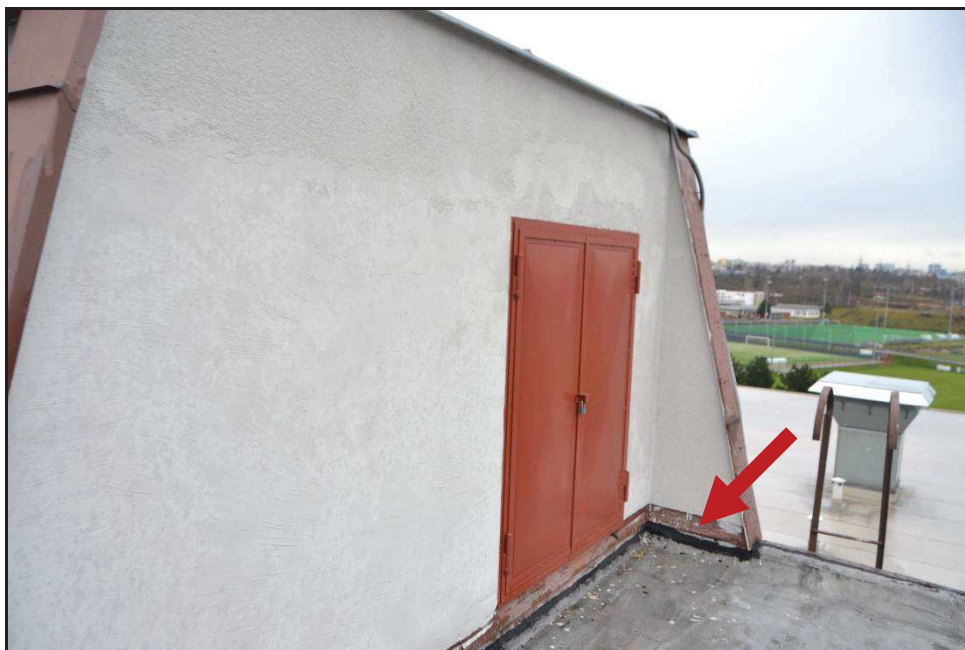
Střešní nástavba nad objektem tělocvičen, dožívající detaily ukončení hydroizolace na svislou konstrukci – netěsnosti, riziko zatékání
